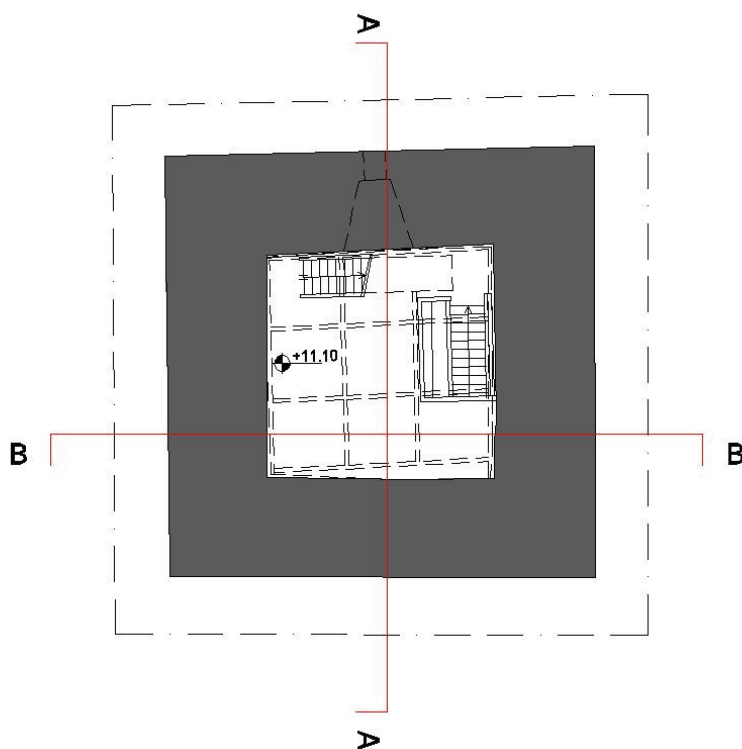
Pianta piano secondo della torre campanaria - Chiesa S. Francesco, Leonessa
